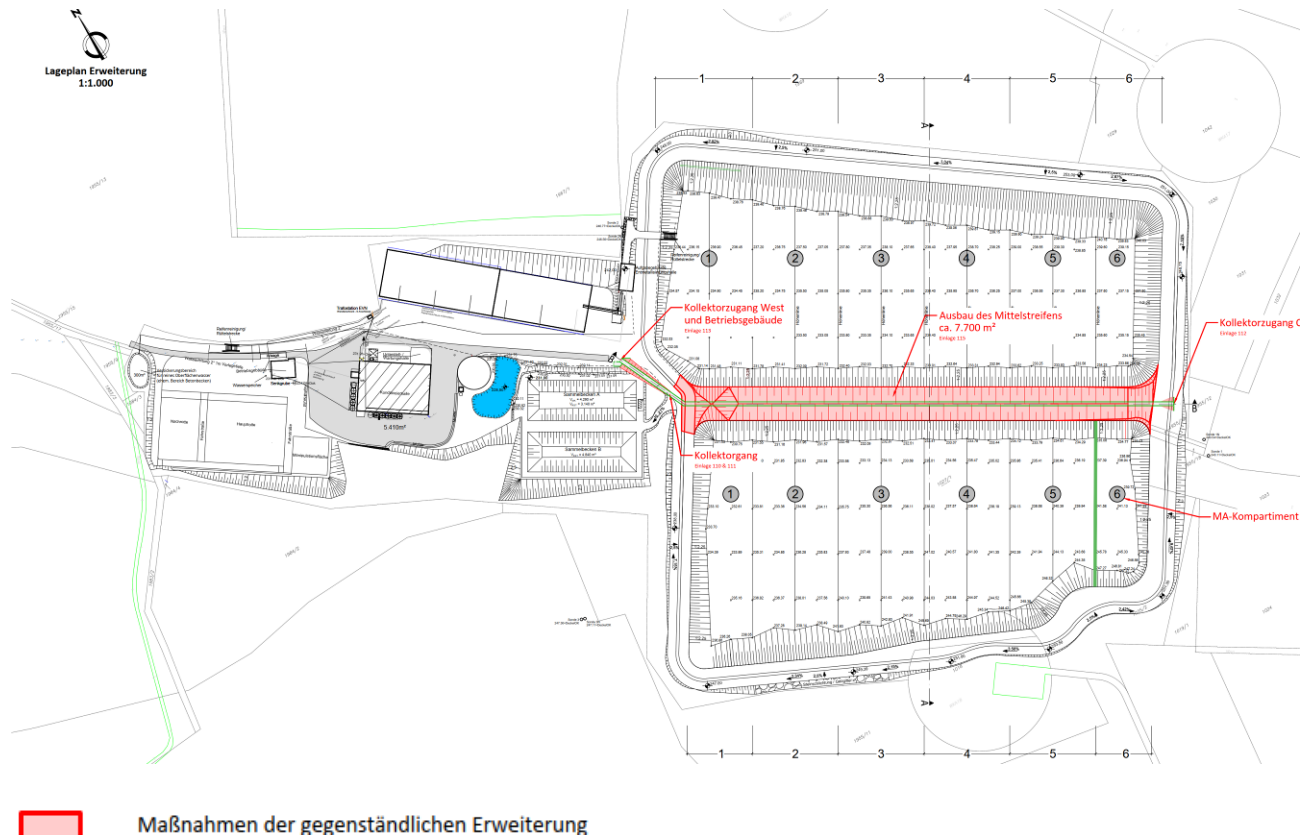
Lageplan ggst. Vorhaben (Quelle: Einreichoperat, Einlage 105)
